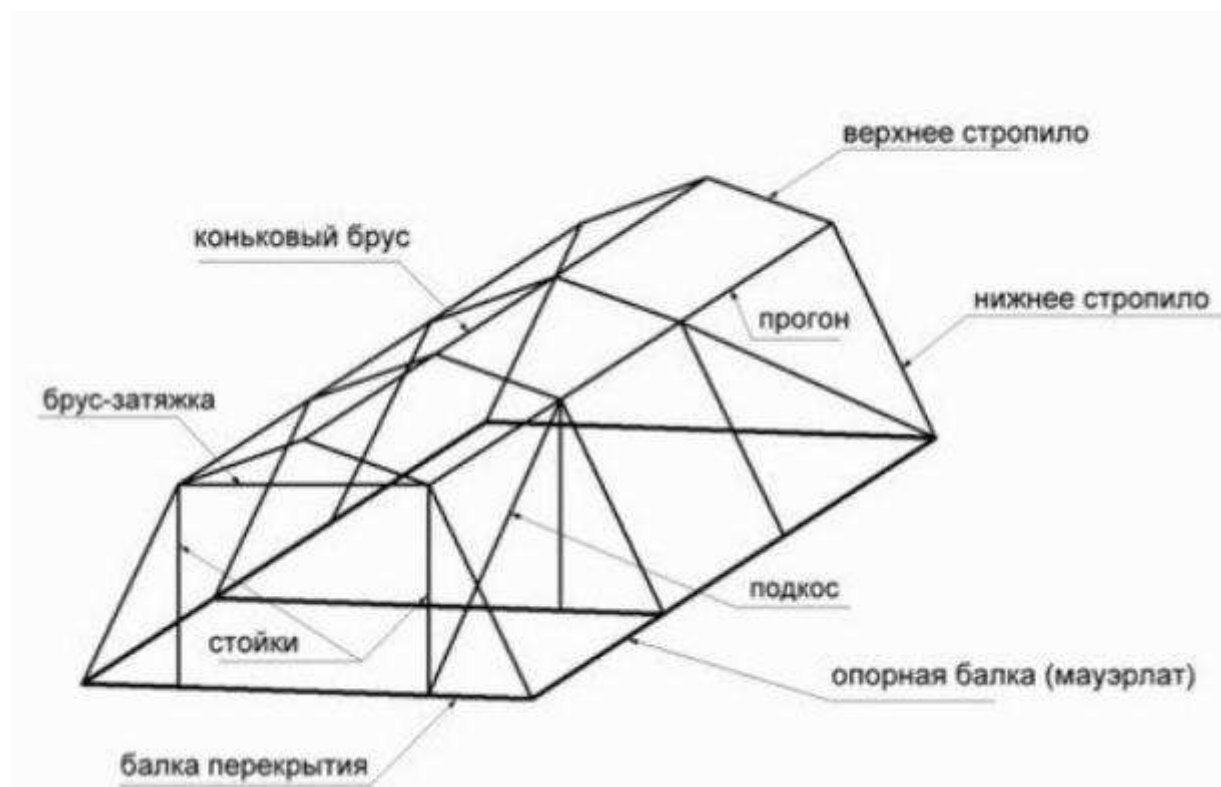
Конструкция стропильной системы мансардной крыши
